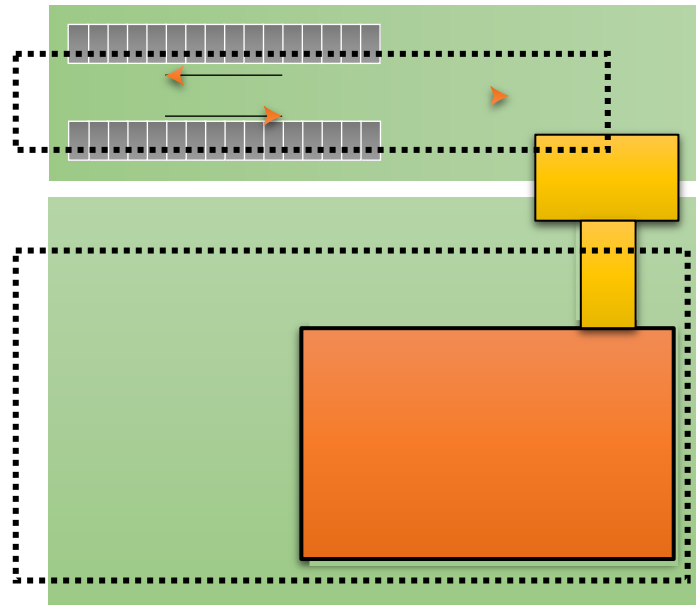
Organizimi i parkingjeve i të punësuarve në kompleks. Brenda apo jashtë gardhit fizik të kompleksit dhe në afërsi të drejtpërdrejtë të portës hyrëse.
